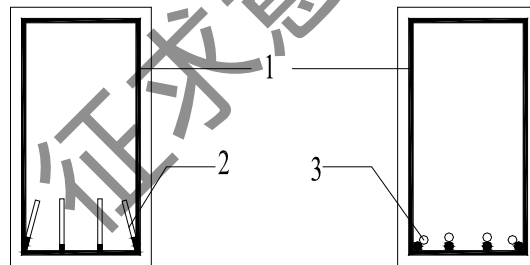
钢筋弯钩和机械锚固的形式与技术要求
